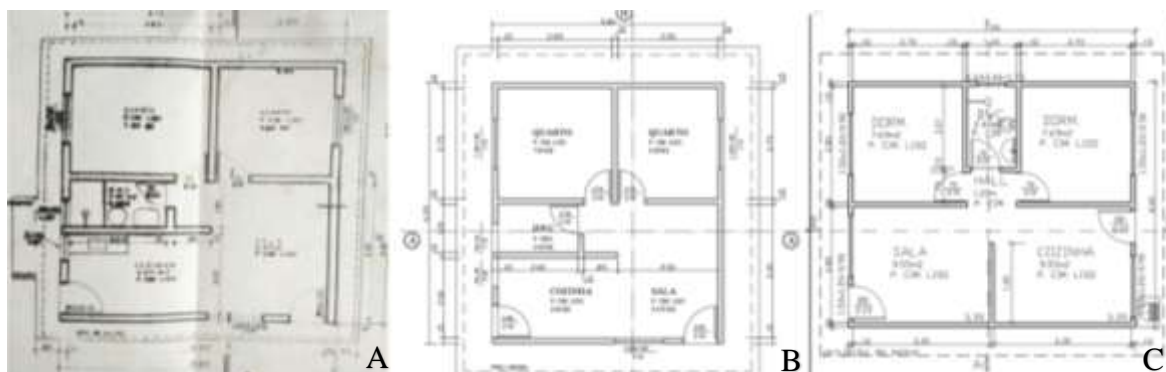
Planta Baixa Habitar Brasil A; Santo Antônio b e Limoeiro C.
